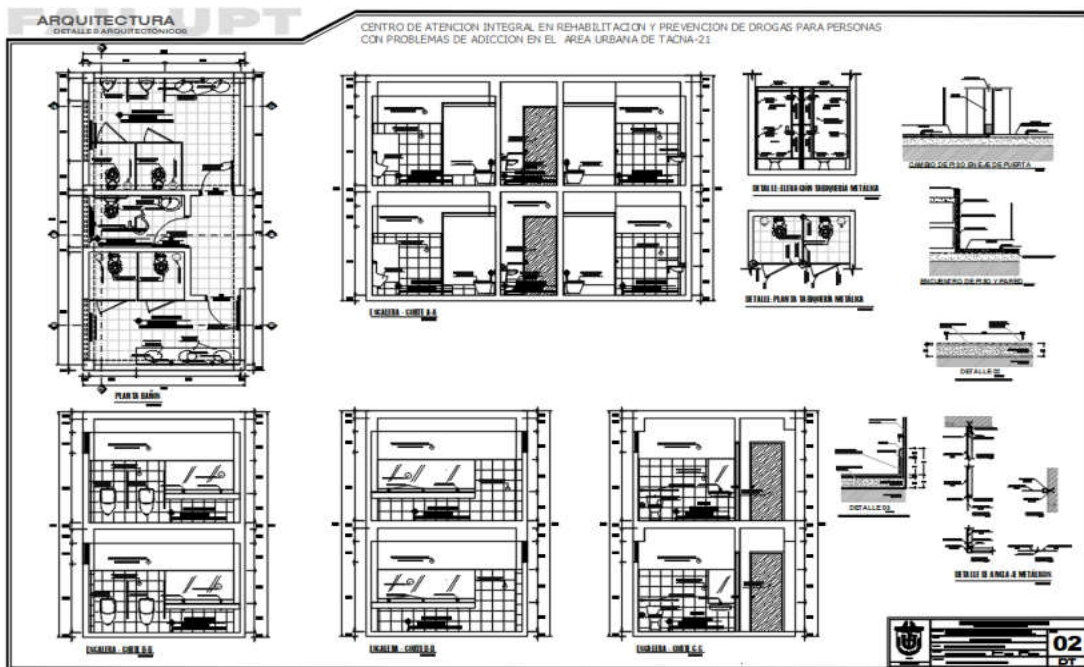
detalles arquitectónicos-Baños, fuente elaboración propia.
